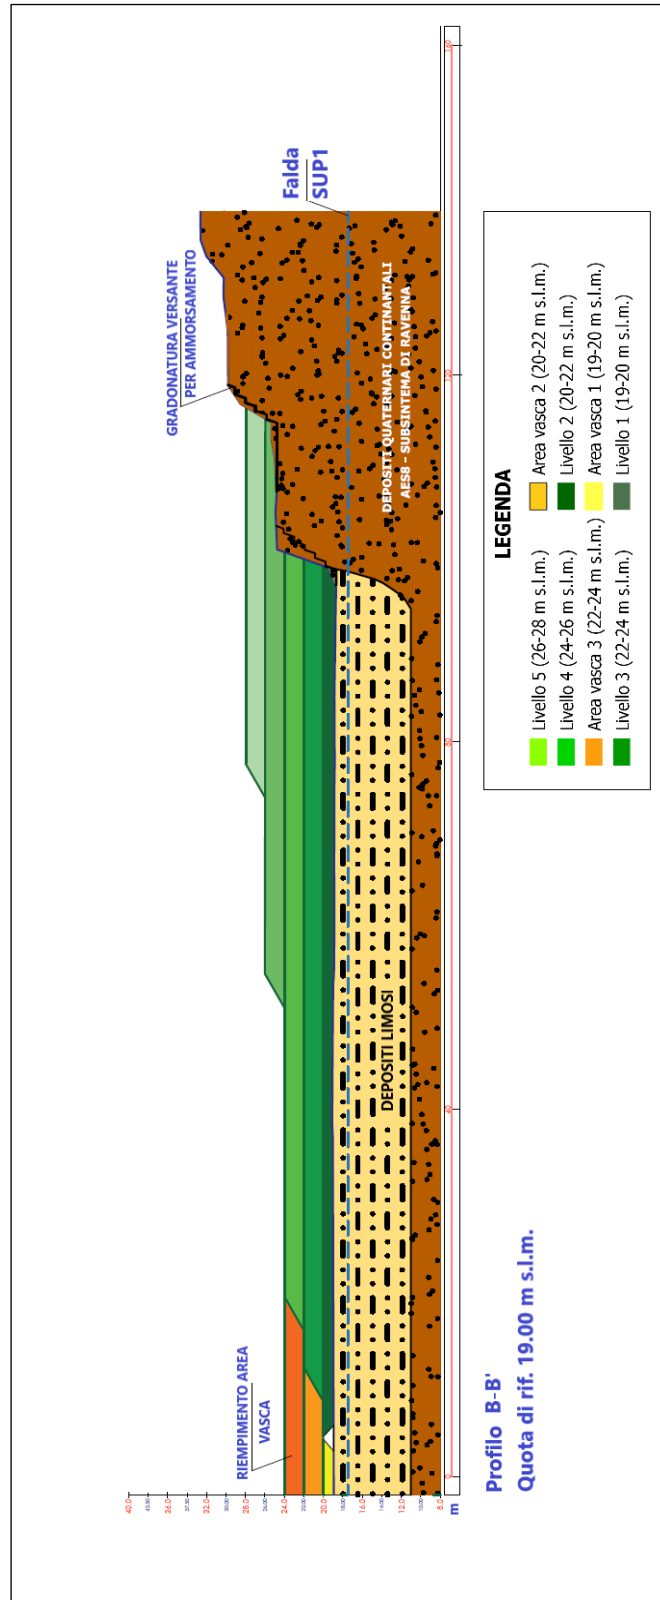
Sezione B- B' sul versante ovest di Cava Olmi
